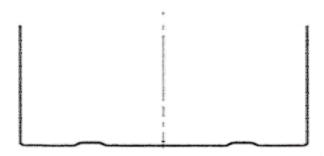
Coupe transversale d'un élément d'ossature métallique « Rail 90 »
